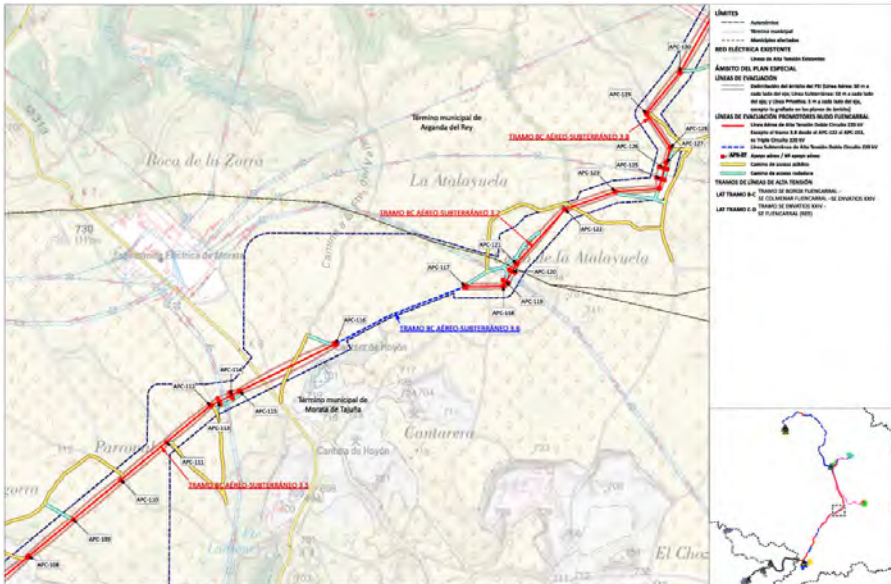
Plano de Ordenación O2.3.9. Planta por tramos. LASAT Promotores Nudo Fuencarral Tramo B-C
